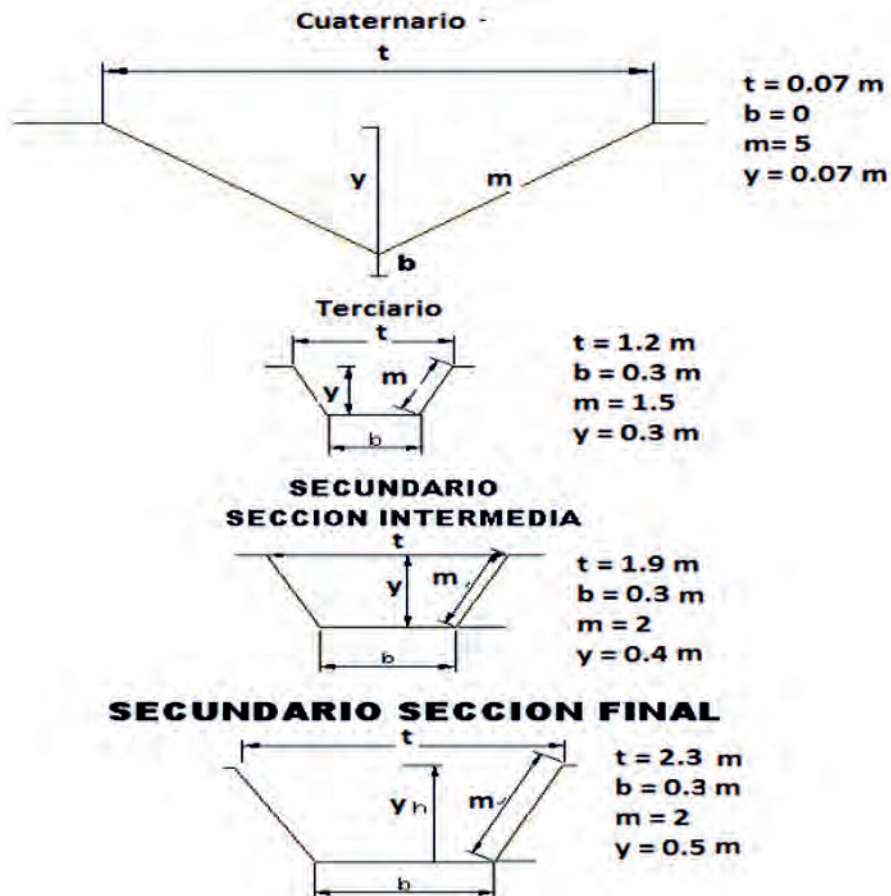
Secciones transversales de los canales a construir en el sistema de drenaje.
